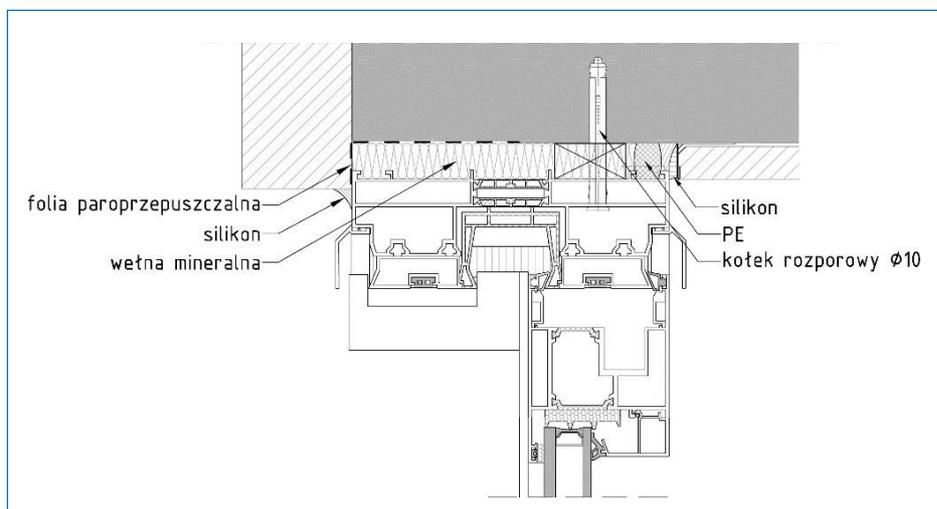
Beispiel für den Einbau einer Balkontür in eine massive, von außen gedämmte Wand - vertikaler Querschnitt durch den Sturz
